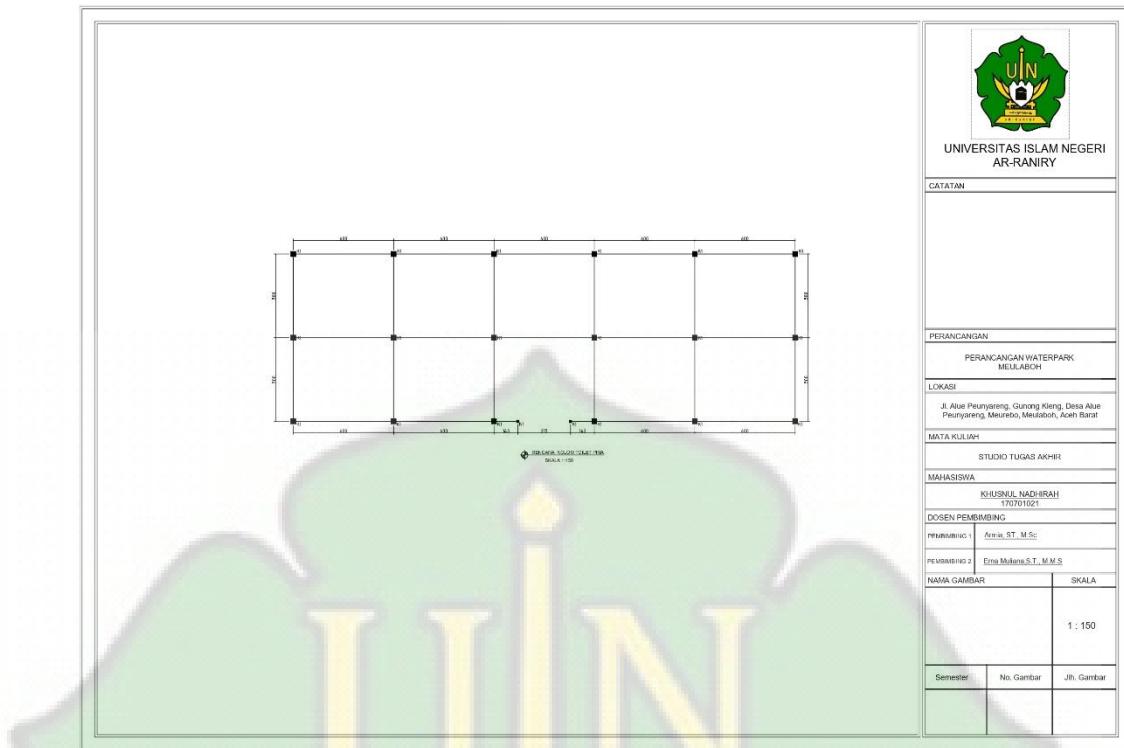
Detail Rencana Kolom Pos Satpam
